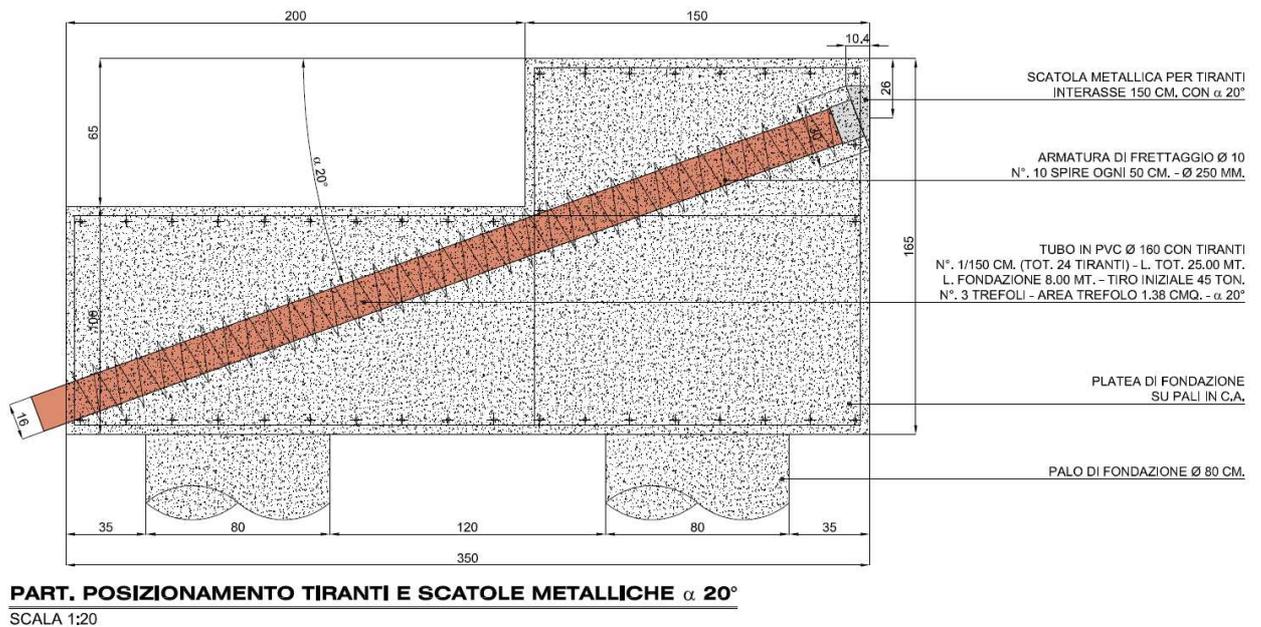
Particolare della posizione di tiranti in corrispondenza della platea di collegamento dei pali
